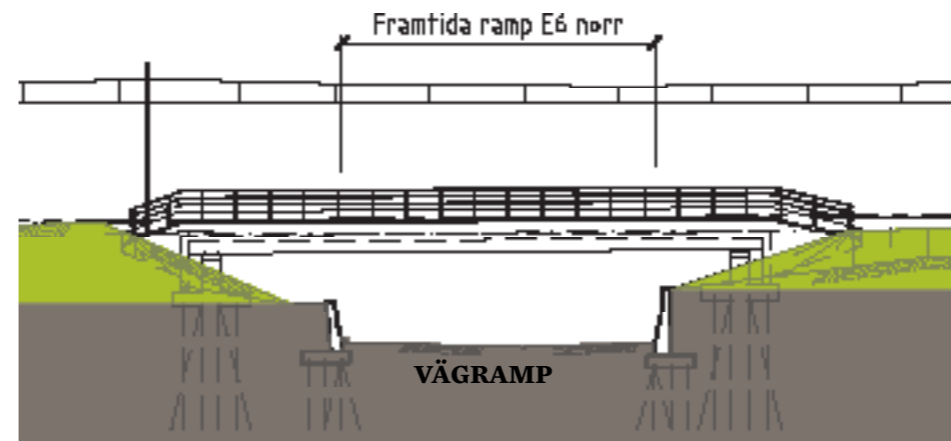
Järnvägsbro för ramp tillhörande Marieholmstunneln.
